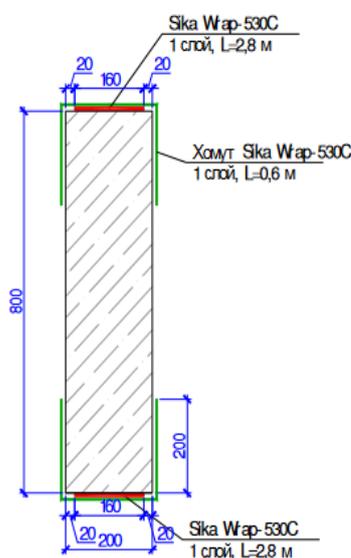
Схема усиления сечения пилона продольным внешним армированием
